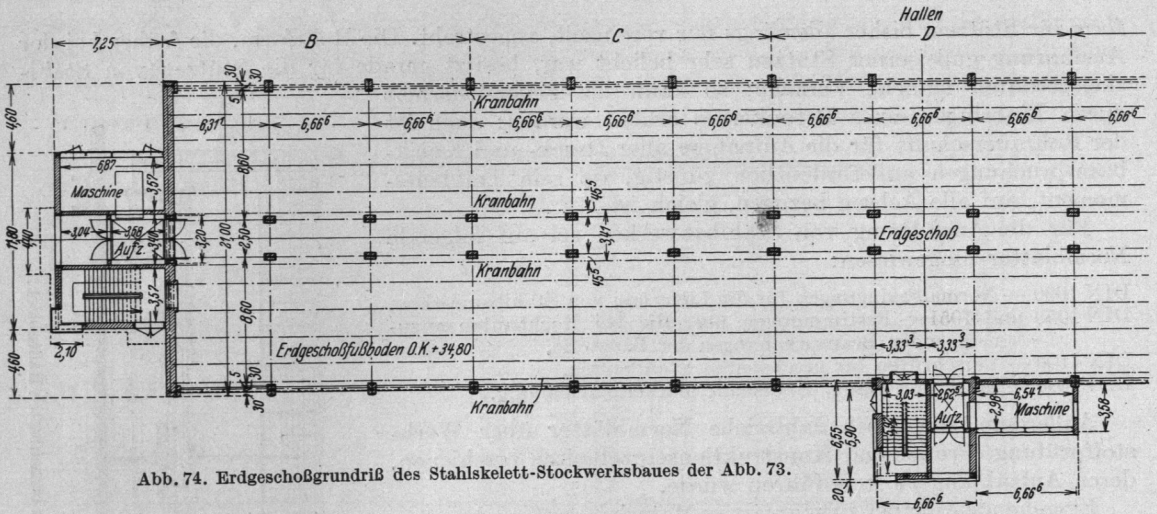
Erdgeschoßgrundriß des Stahlskelett-Stockwerksbaues der Abb. 73.
